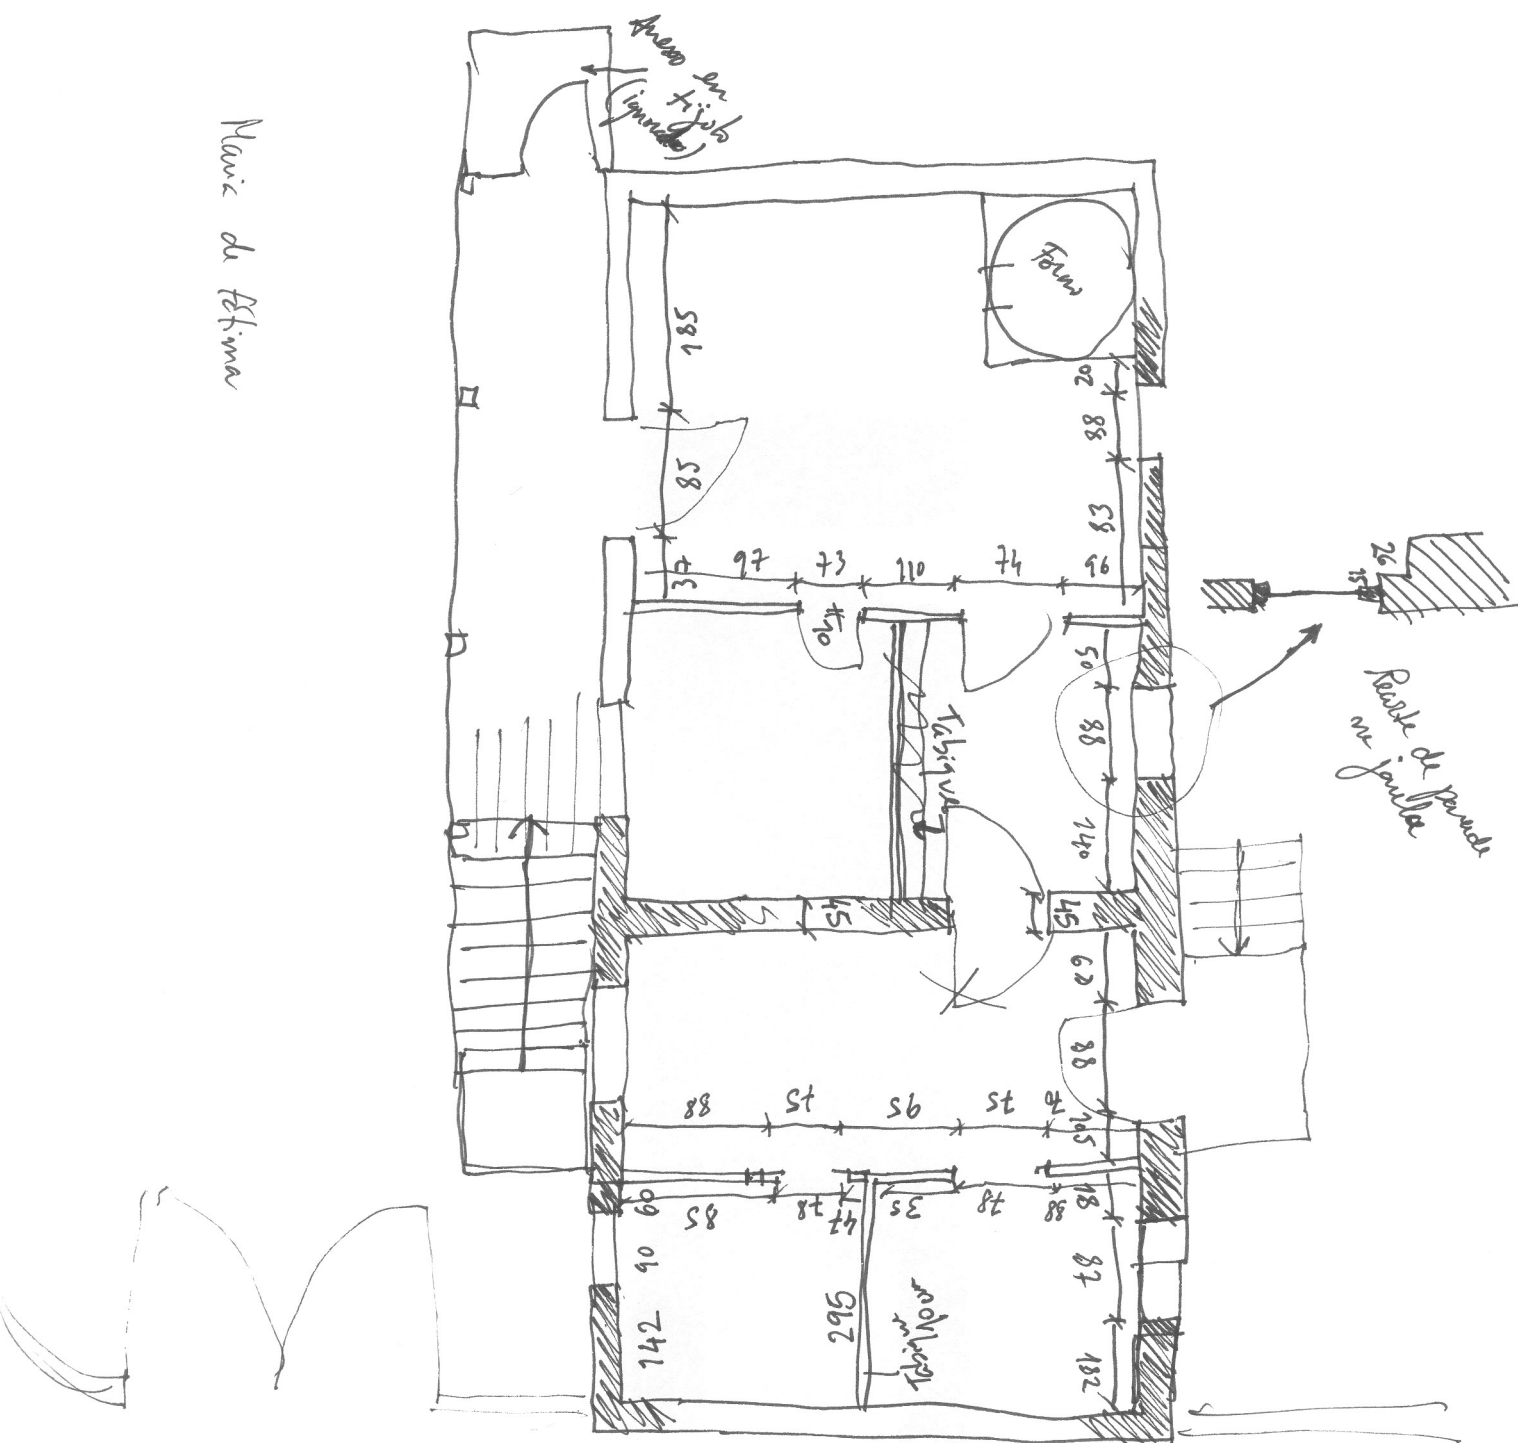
Planta de levantamento. Casa Bloco [OlFrades3] , pág. 108
